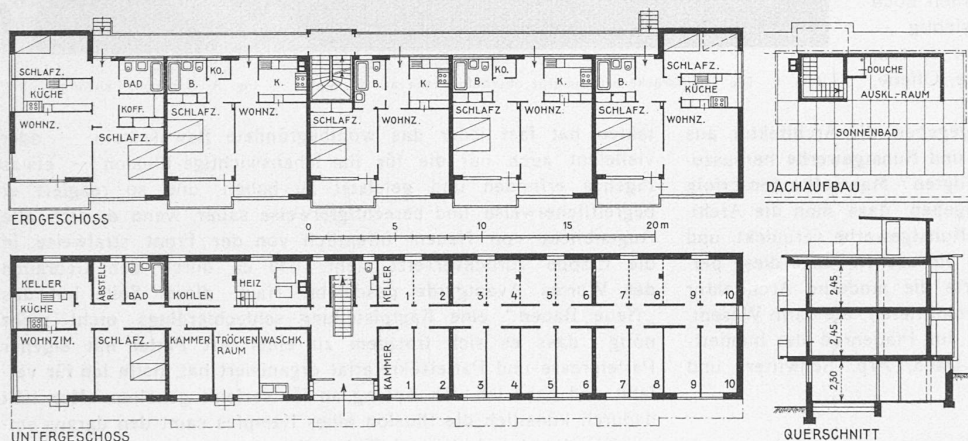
Grundrisse und Schnitt. — Masstab 1 : 400.
